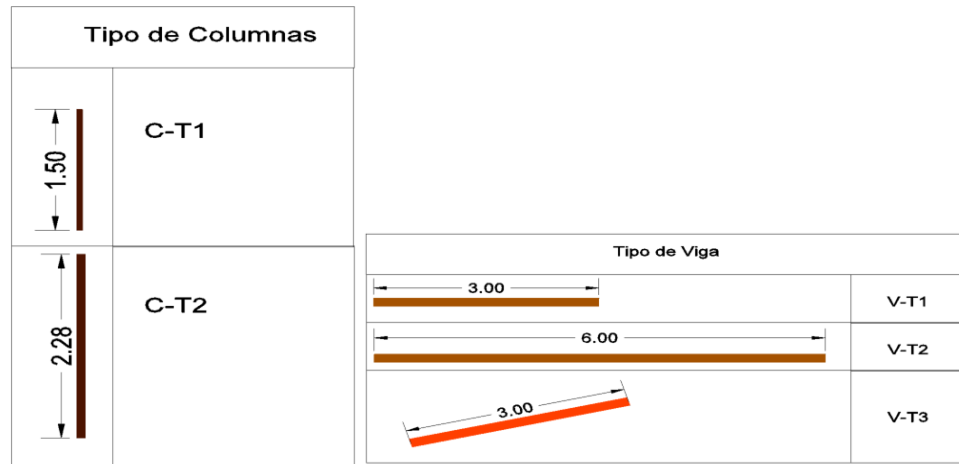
Tipología o nomenclatura de las columnas y vigas Ref. (Silva & Valencia, 2023)
